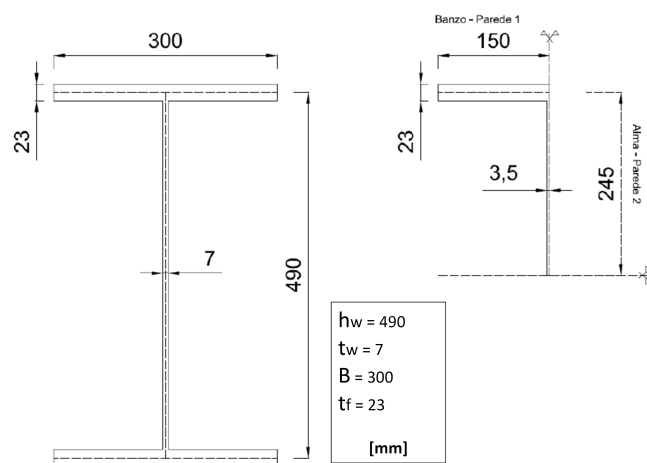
Geometria da secção em «I» e respectiva simplificação de simetria/anti-simetria
